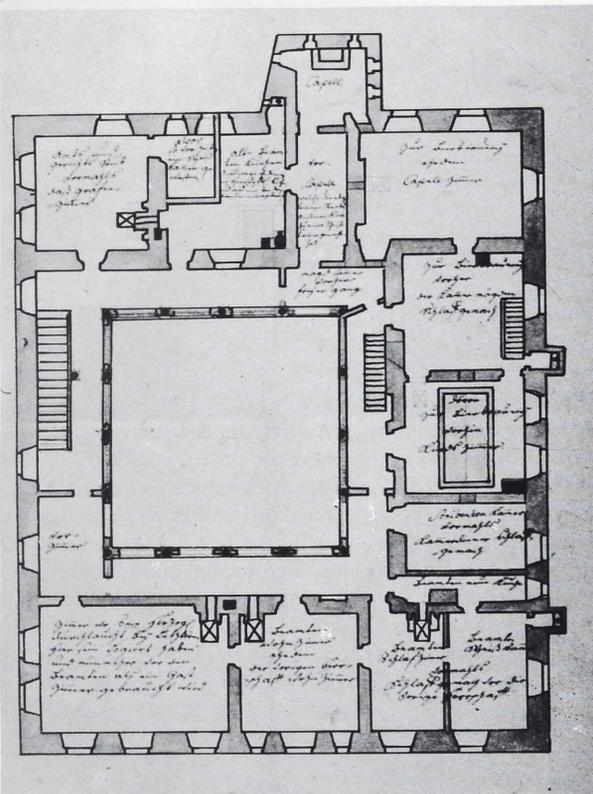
Grundriß erstes Obergeschoß 1779 (Vorlage und Aufnahme HStA Stuttgart, A 402, Bü. 35. Alle Rechte vorbehalten).
